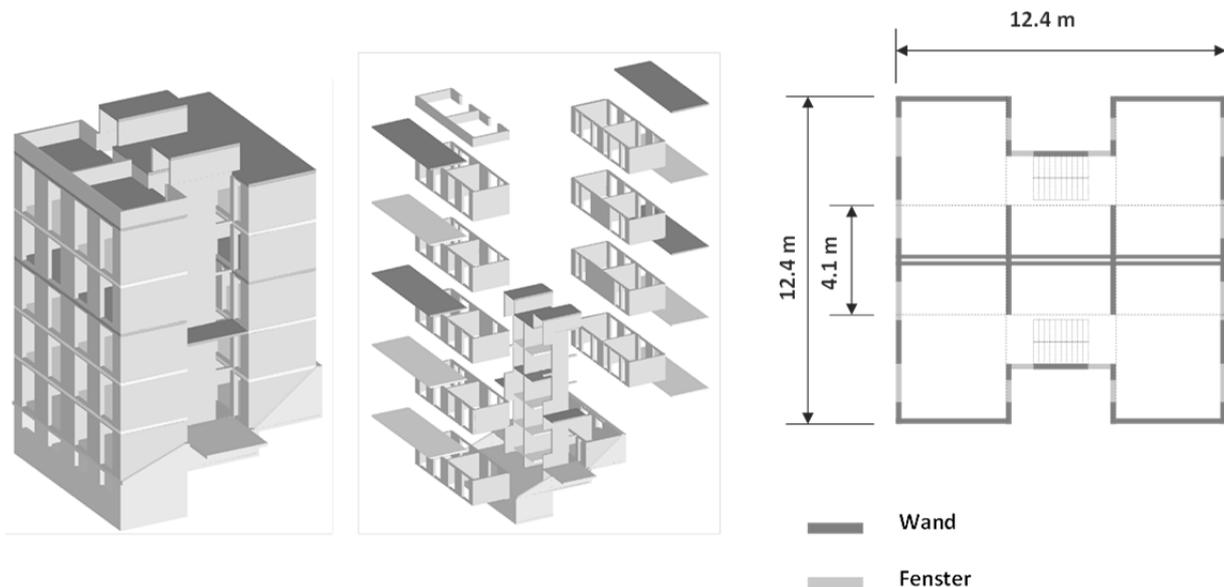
Übersicht und Grundriss des Gebäudes
